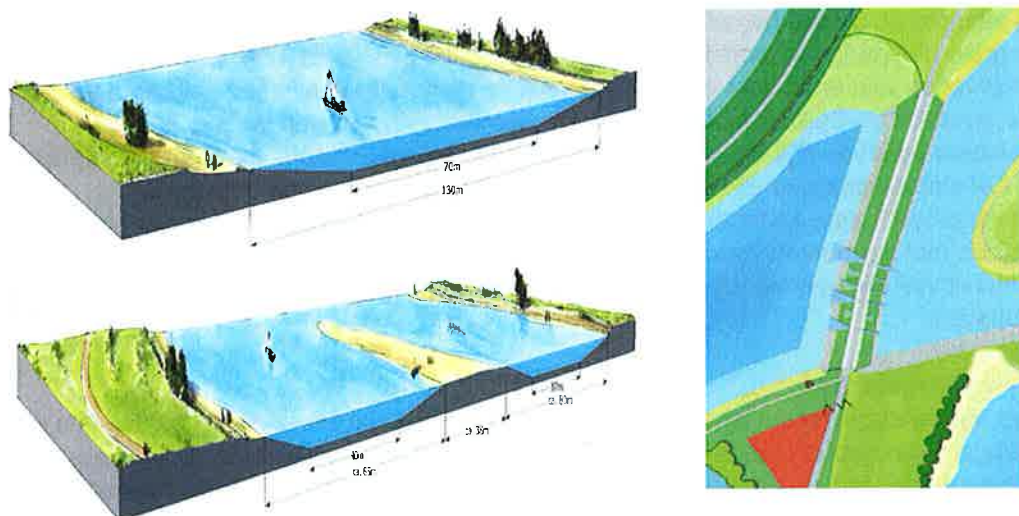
Voorgenomen ingreep uit het Ruimtelijk Plan 2010
